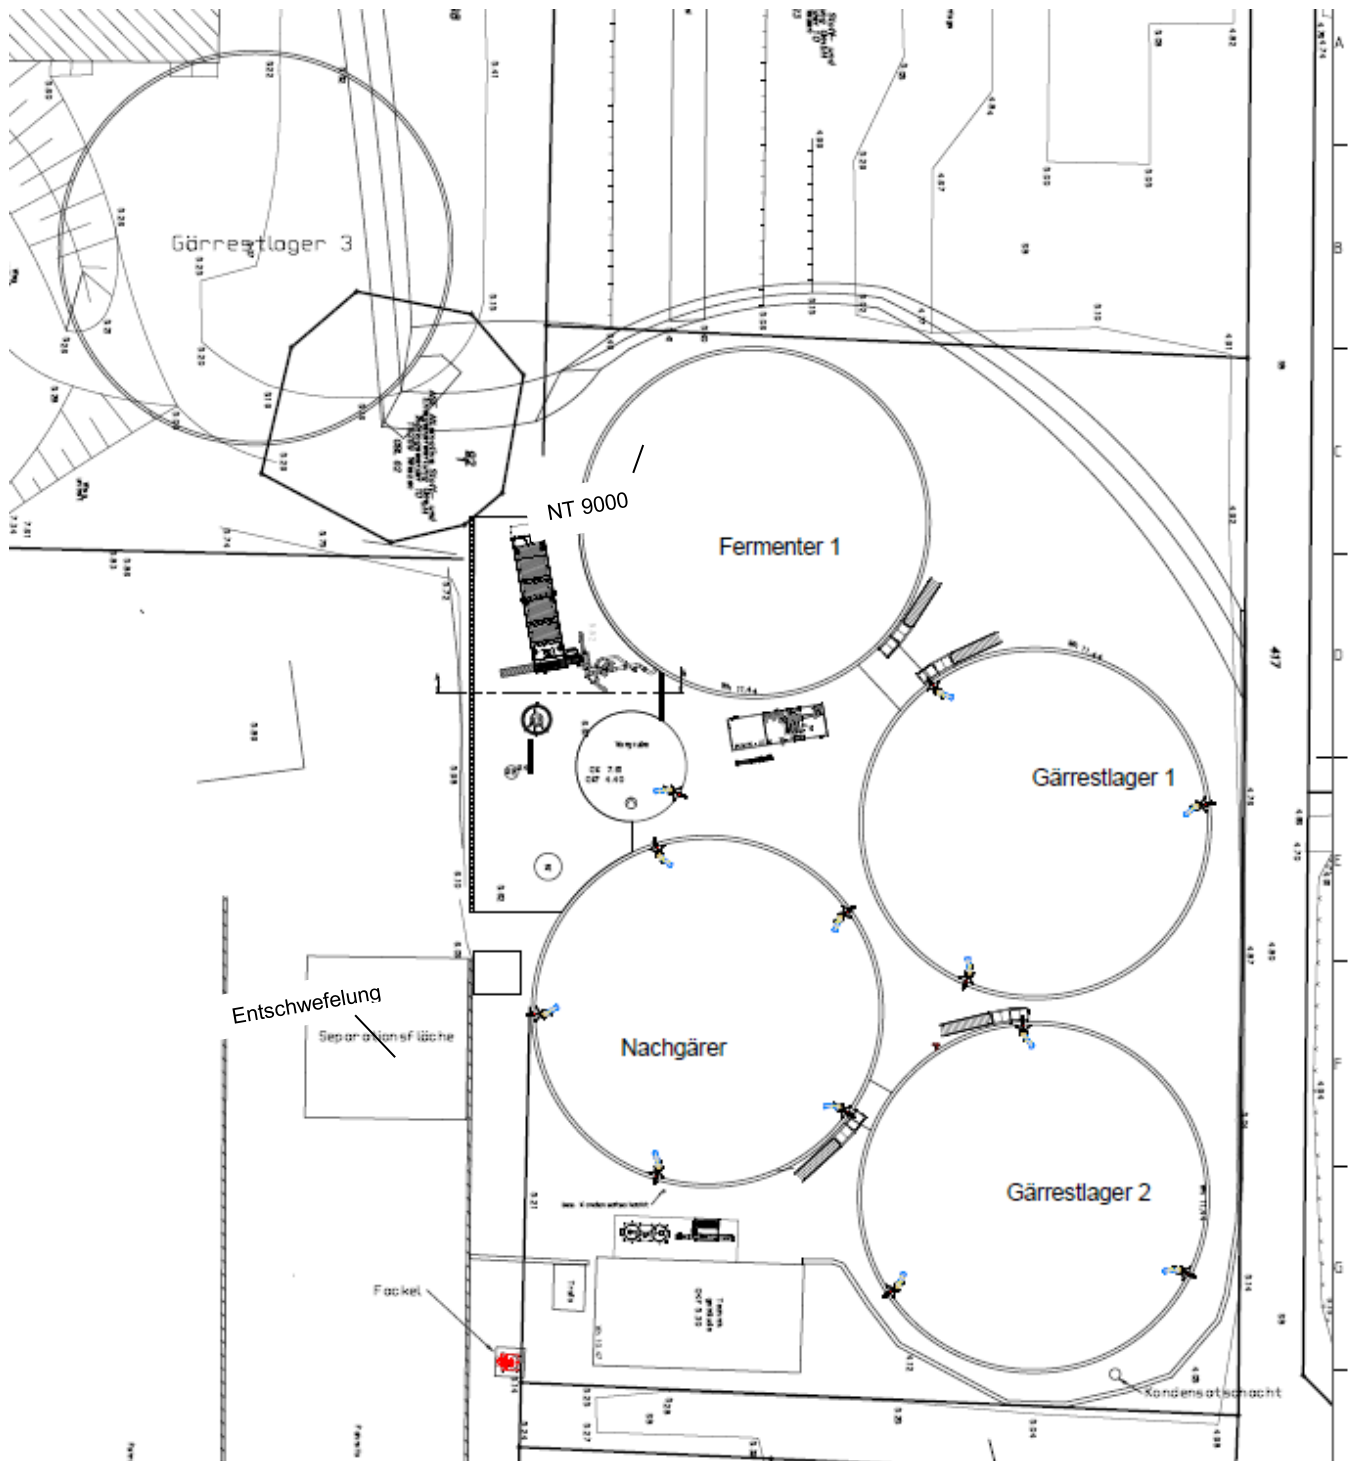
Lageplan Thöringswerder ergänzt um GRL 3
